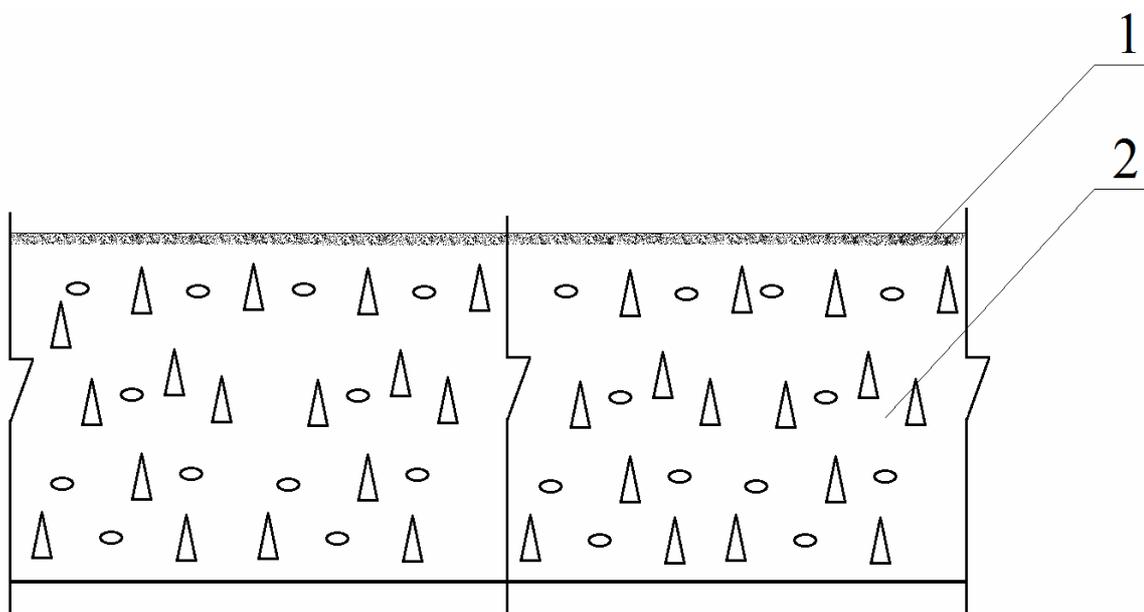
Пропитки полимерные для бетонной плиты на грунте
